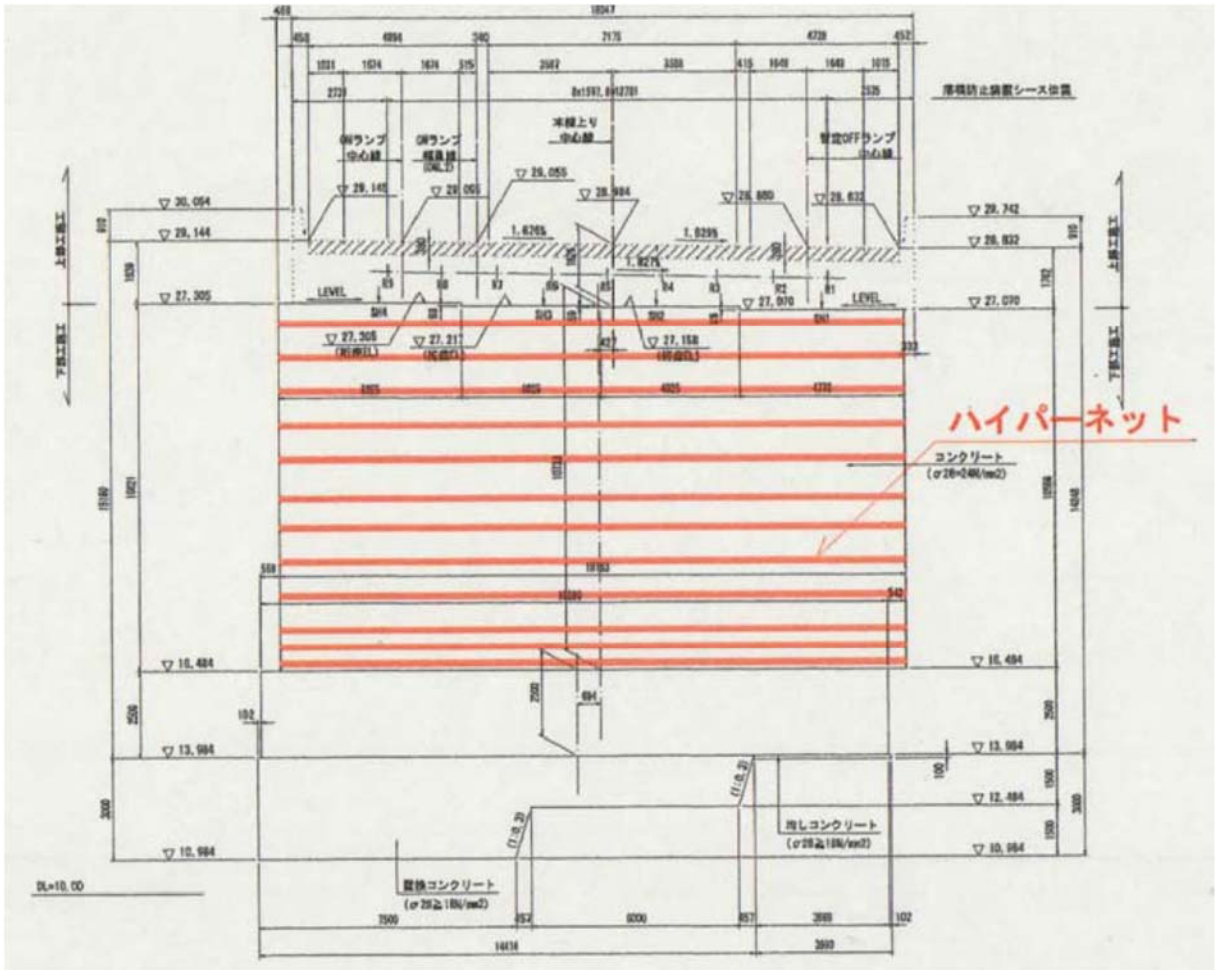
ひび割れ抑制用ネット設置位置図 (橋台)
